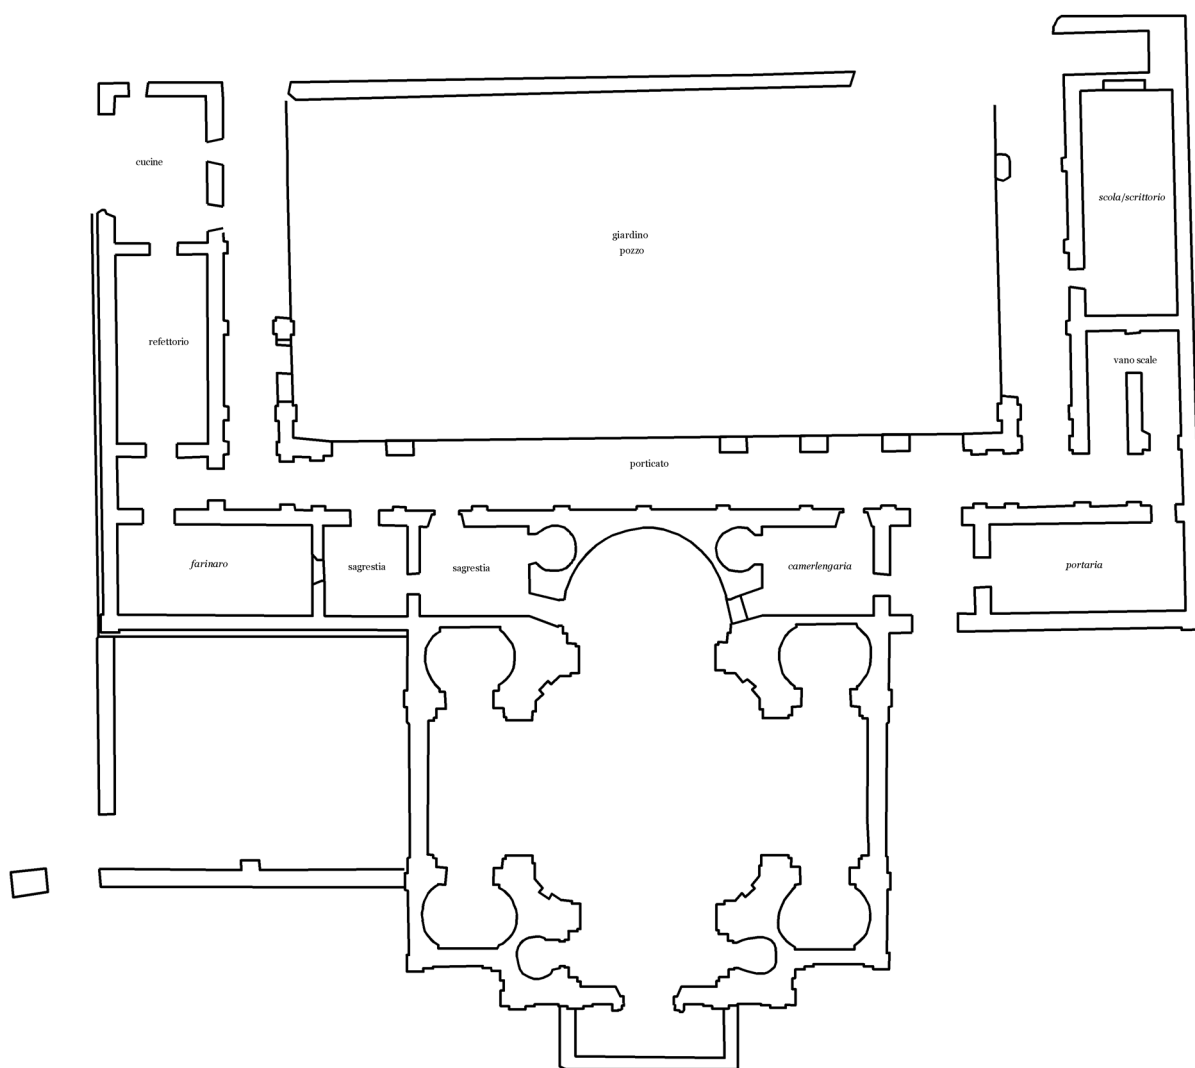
Planimetria dei resti del convento, piano terreno (da Benucci, Romagnoli 2009).
